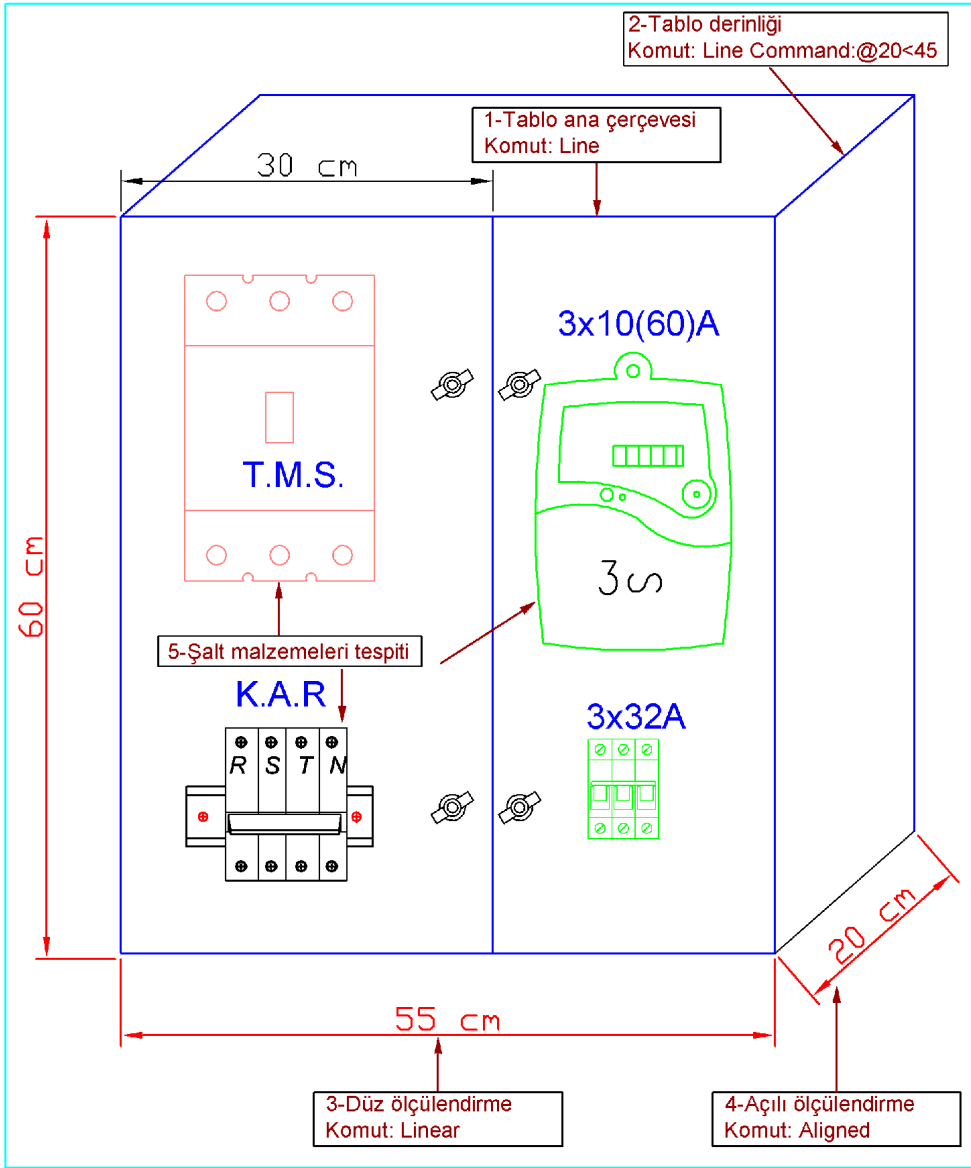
Dimension araç çubuğu -Linear ölçülendirme
